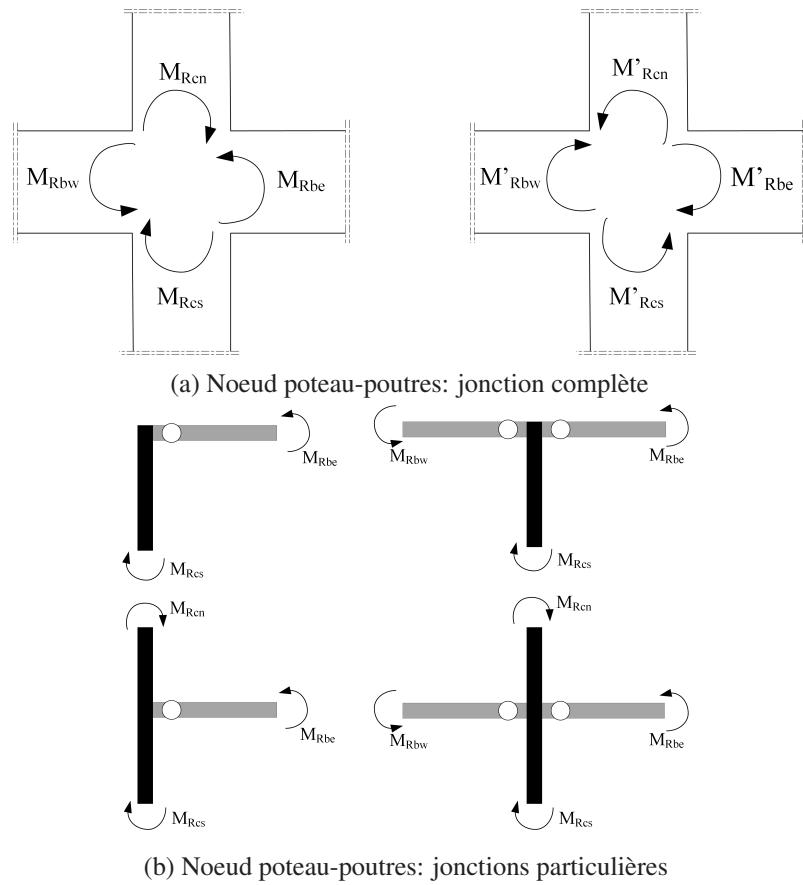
Dimensionnement d'un nœud poutre-poteau
